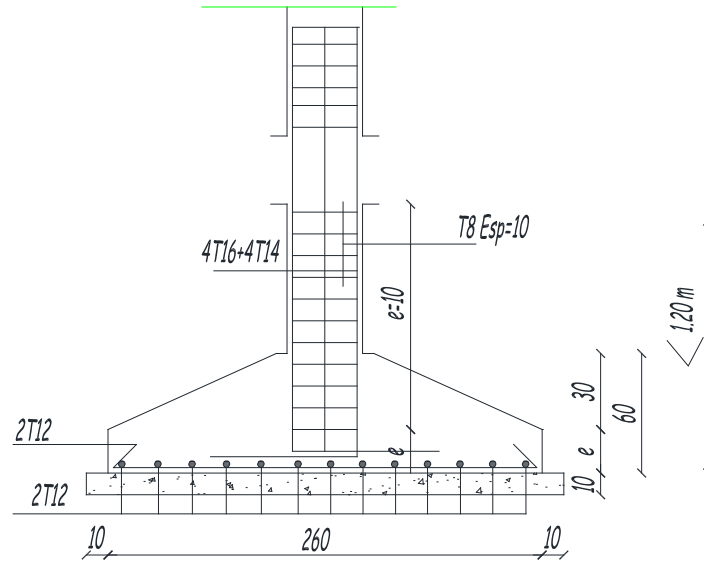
Schéma de ferrailage des semelles isolées.
